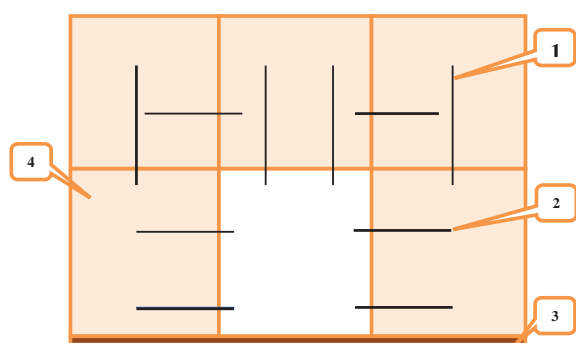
Конструкция искусственной потолочины без армирования: 1 – вертикально расположенные анкеры; 2 – горизонтально расположенные анкеры; 3 – породная подушка; 4 – заложённая очистная выработка
